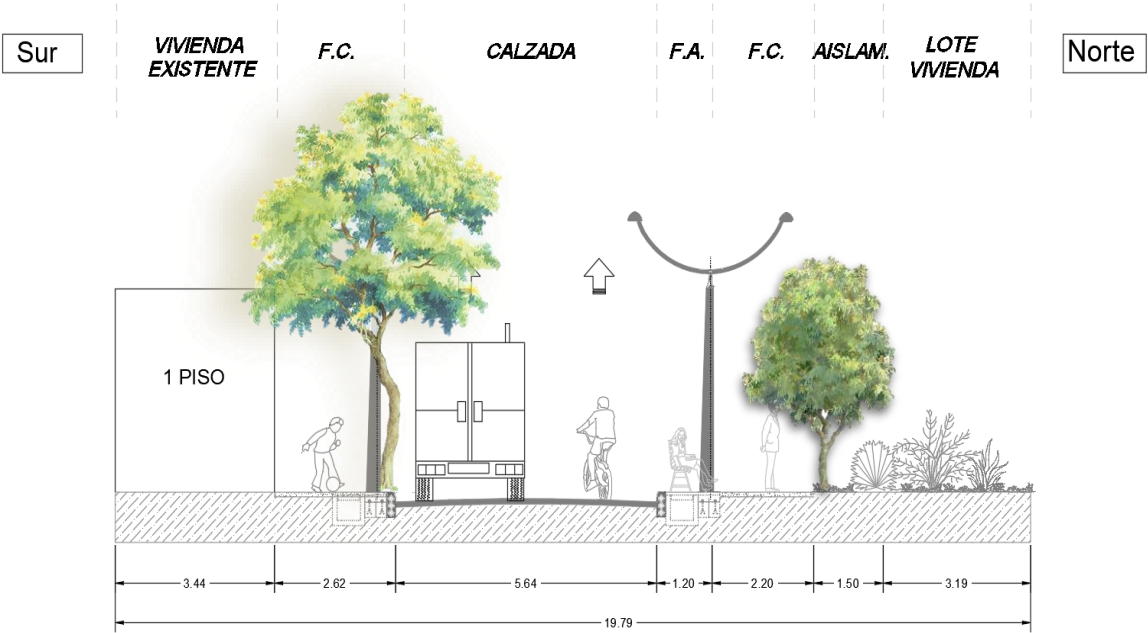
Perfil vial Calle 5, Cantagallo, Bolívar
